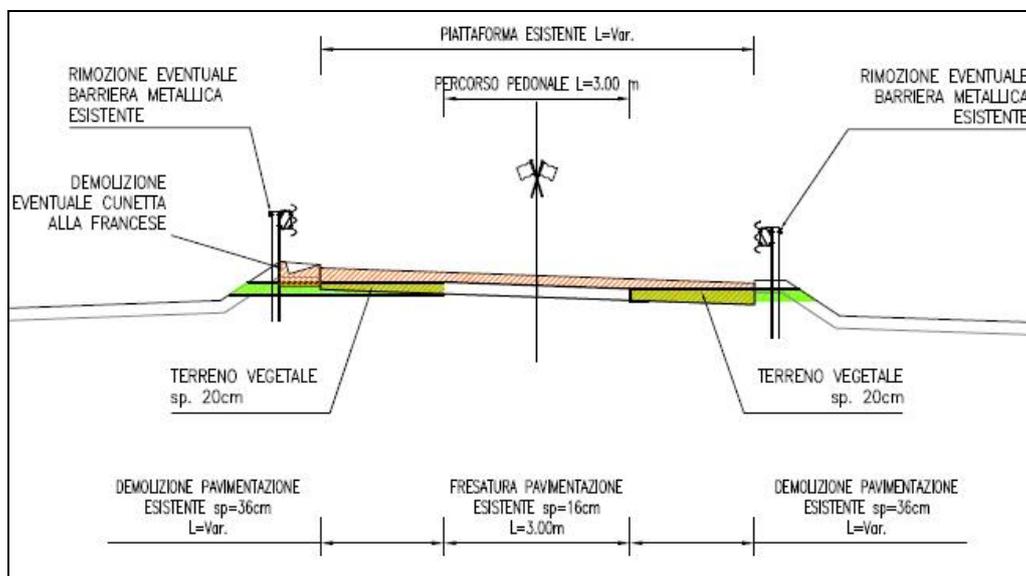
Schema demolizione pacchetto di pavimentazione flessibile
